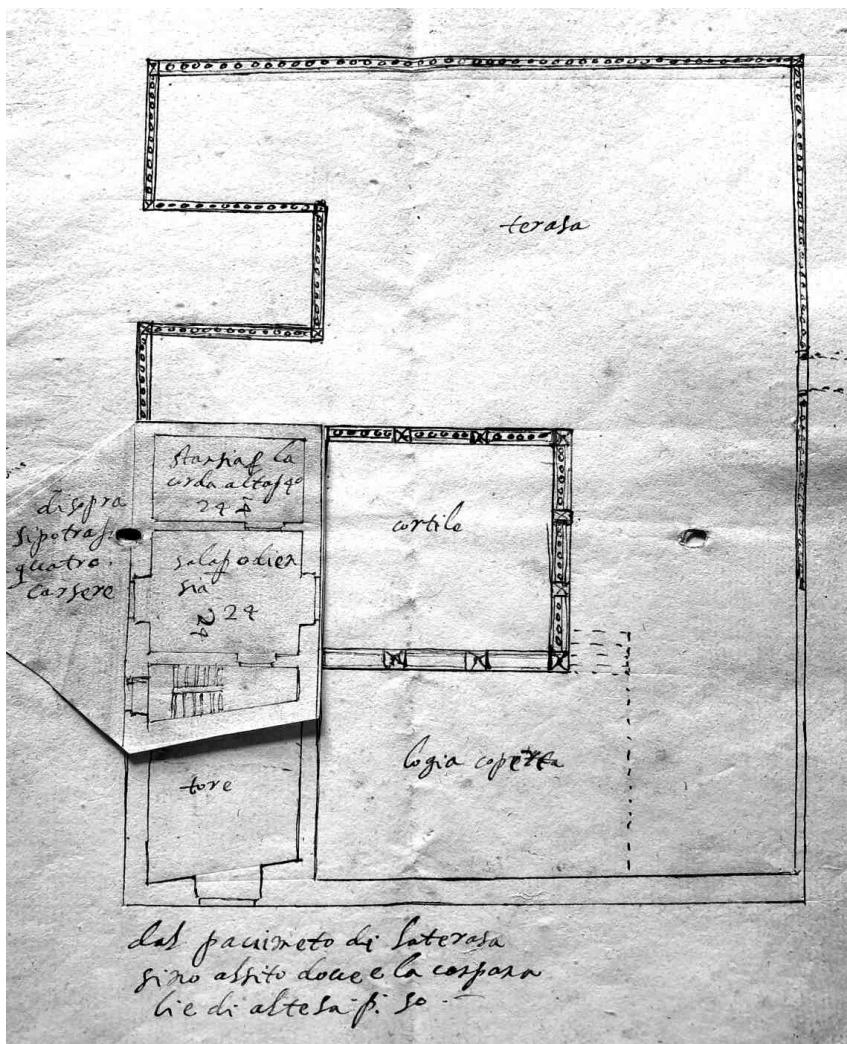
Pianta di progetto della parte sud-ovest del Palazzetto, pianta del terzultimo piano della torre, sopra cui « si potrà fare quattro carsere » e vi sarà ancora « il sito dove è la campana », sopraelevato di 50 palmi rispetto al « pavimento di la terasa » (ASGe, *Archivio segreto* 1650, fasc. 63, « modello » allegato al decreto dell'8 ottobre 1599).
